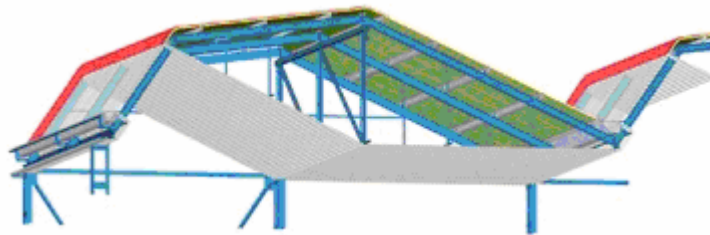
Detalle cubierta sistema Villoor 2 banco
